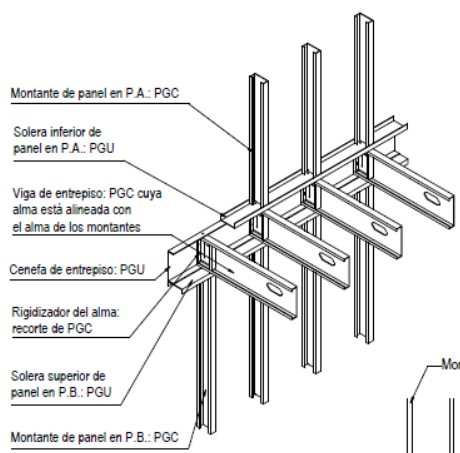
Estructura de forjado. (ConsulSteel, 2002).
